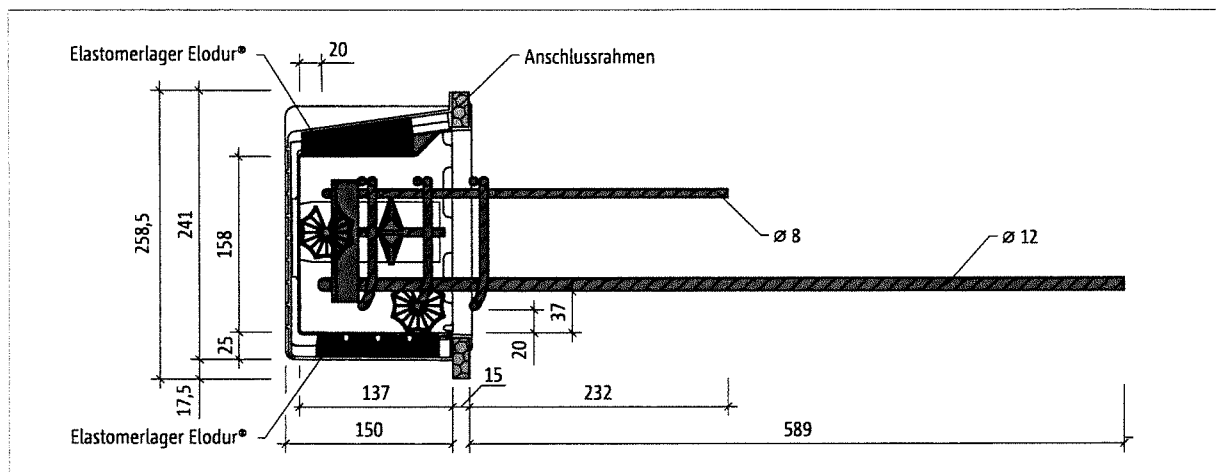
Schöck Tronsole® Typ Z-V+V-T beziehungsweise Typ Z-VH+VH-T: Vertikalschnitt
